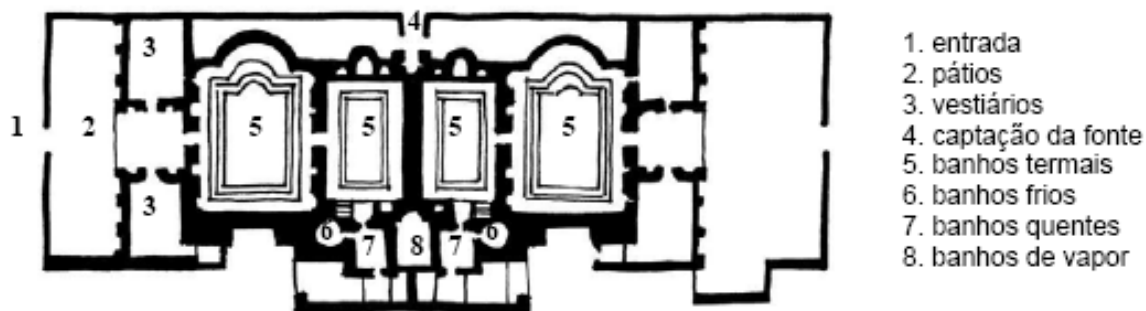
Templo de Badenweiler, Alemanha, séc. 70 d.c. planta
